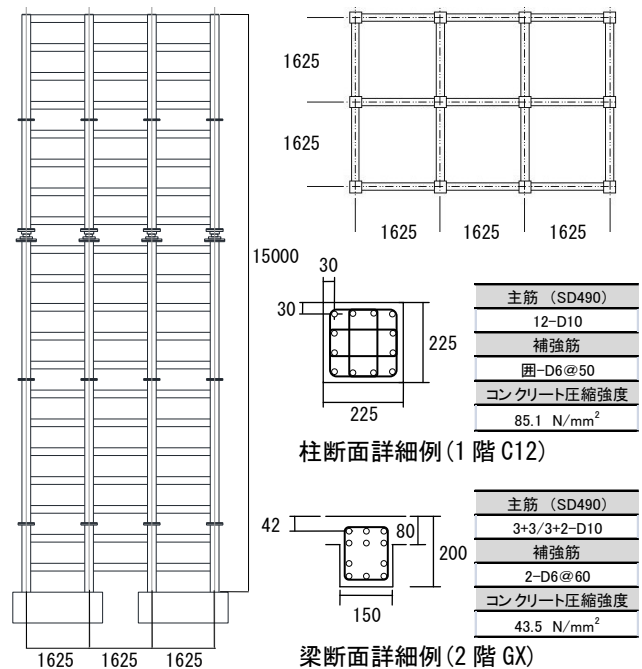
試験体図, 柱・梁断面図 (単位: mm)¹⁾
